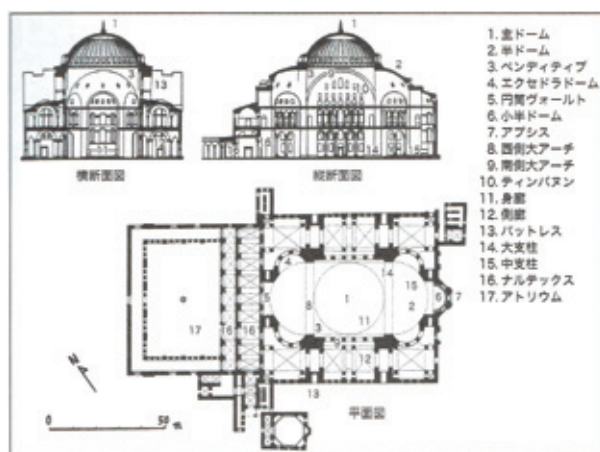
アヤ・ソフィアの平面図および断面図（同図版2と同じ引用）
